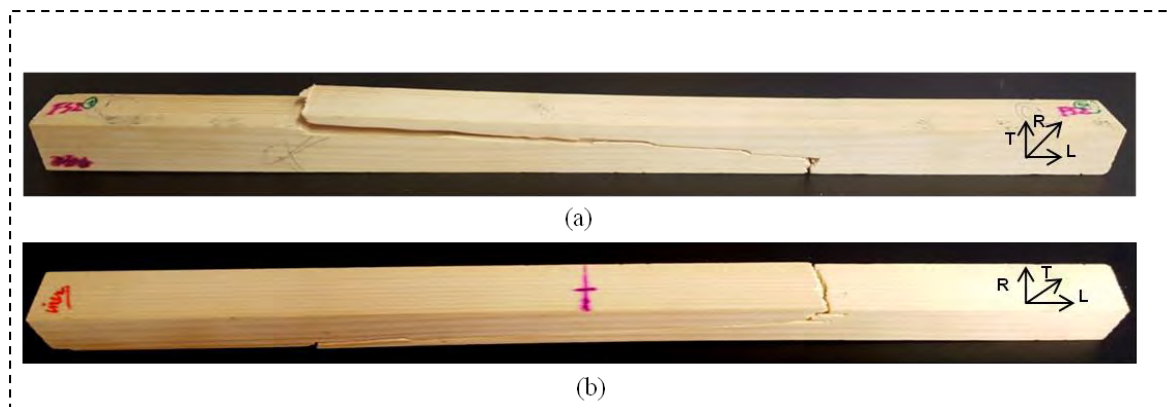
Faciès de rupture de l'éprouvette FS2 (a) face avant LT (b) face tendue LR
